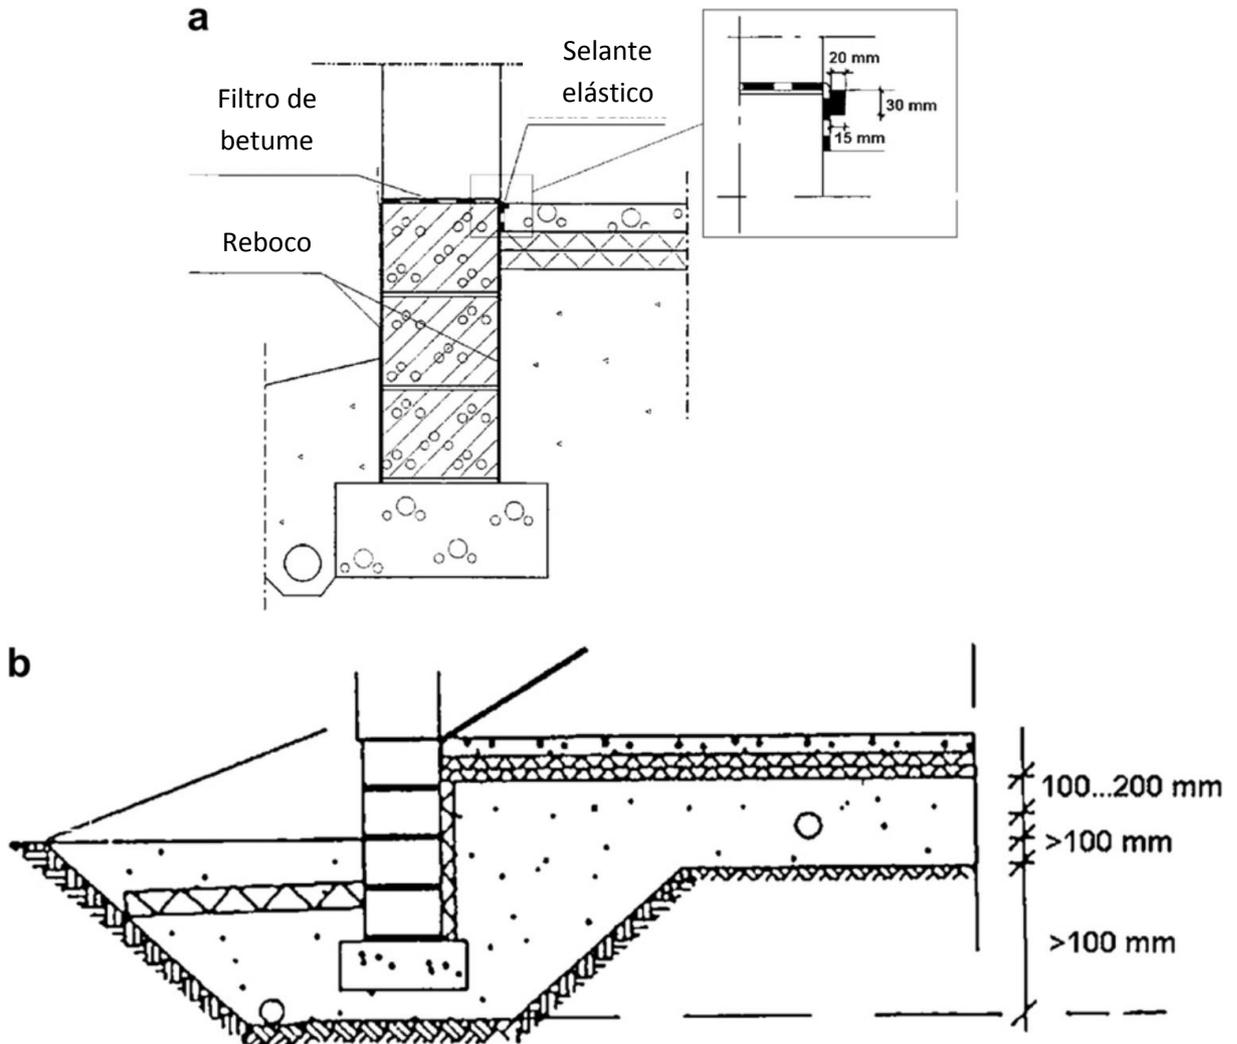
Medidas de proteção para o radão; (a) vedar a junta entre a parede de fundação e laje de pavimento, quando a parede de fundação é feita de material permeável; (b) instalação de um tubo de sucção na camada de gravilha (Arvela, 2001).
